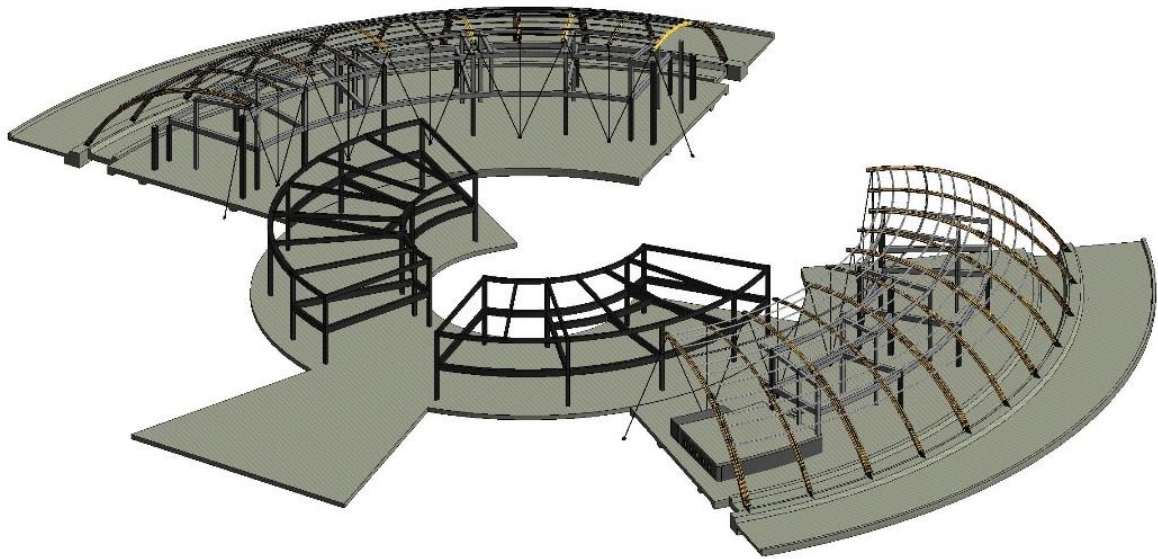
Modelamiento de estructuras (losa, columnas, vigas, cobertura)
